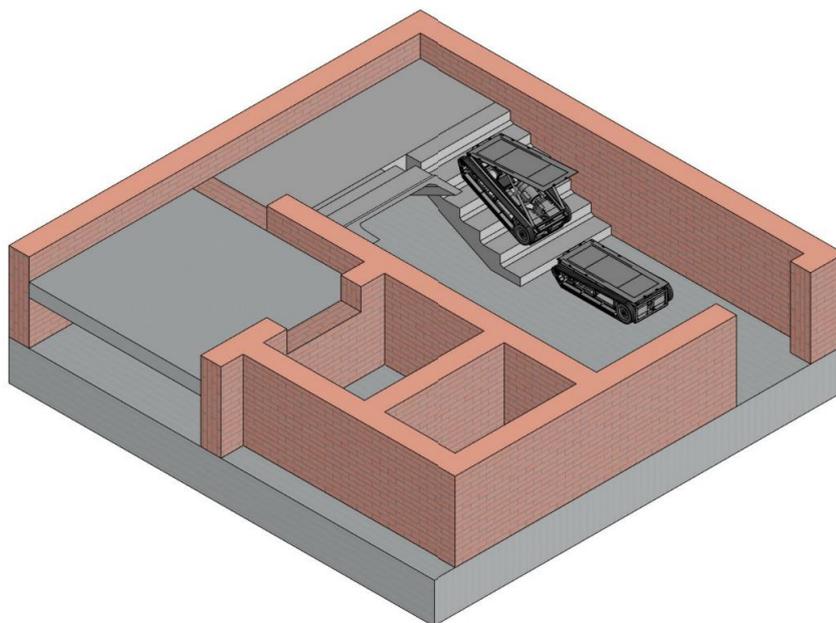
Демонстрация работы гусеничной грузовой тележки, размещенной на лестничной площадке жилого здания
